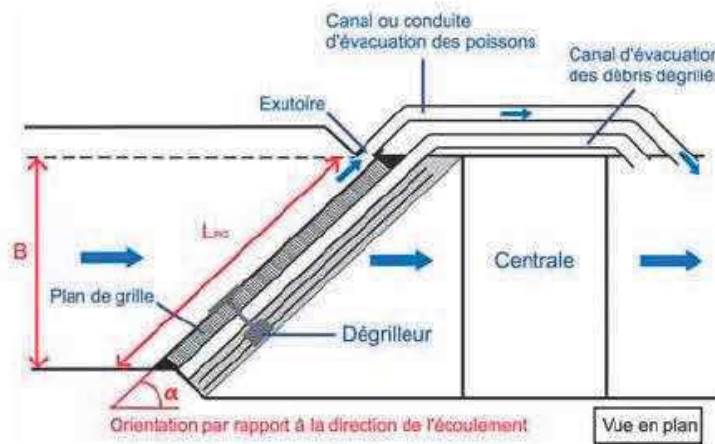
Plan de grille orienté en plan par rapport à la direction de l'écoulement (vue en plan) (selon Courret et Larinier, 2008)
